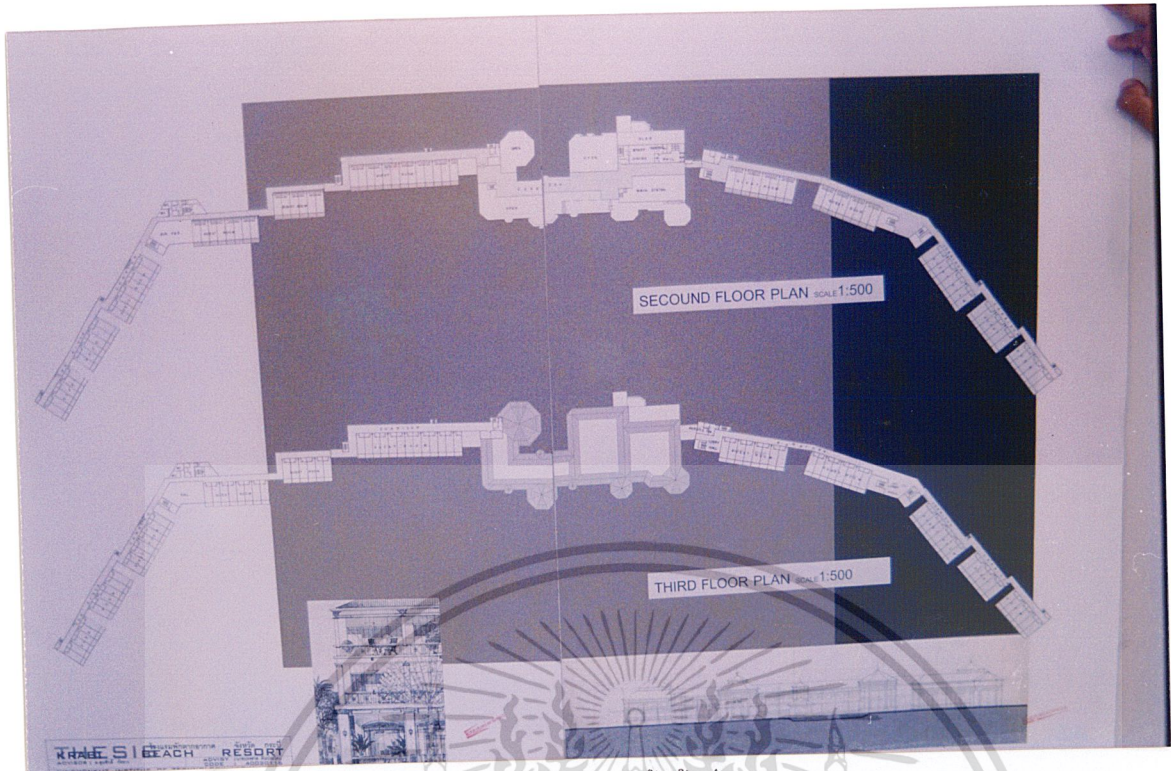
แสดงแปลนแผนผังโครงการ
